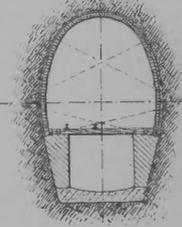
Coupes d'ensemble du projet complet de Galeries
